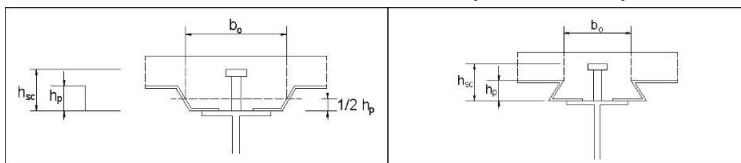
(a) - Disposizione della lamiera grecata rispetto al profilo in acciaio
